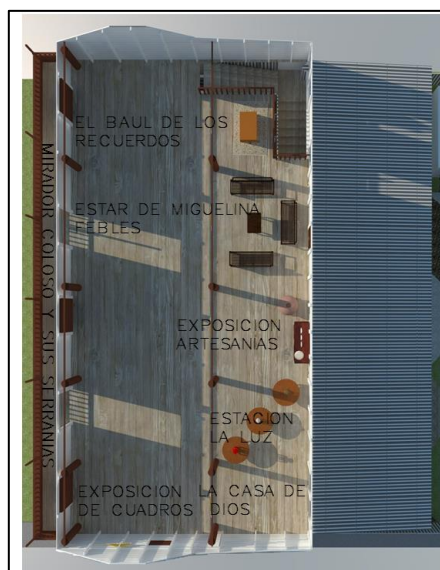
Planta segundo piso. Fuente de elaboración propia (2017).
